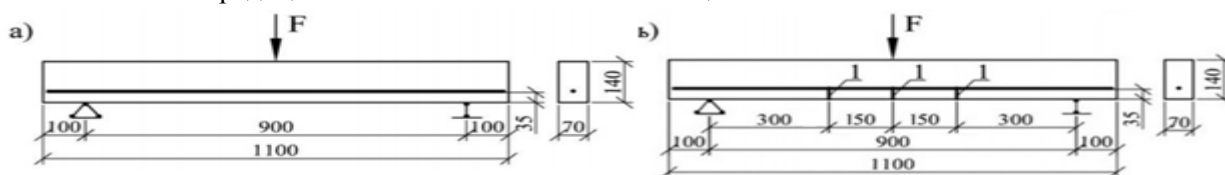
Железобетонные образцы для модельного эксперимента: а – балка сплошного сечения б – с 3-мя организованными трещинами; 1 – организованная трещина.
